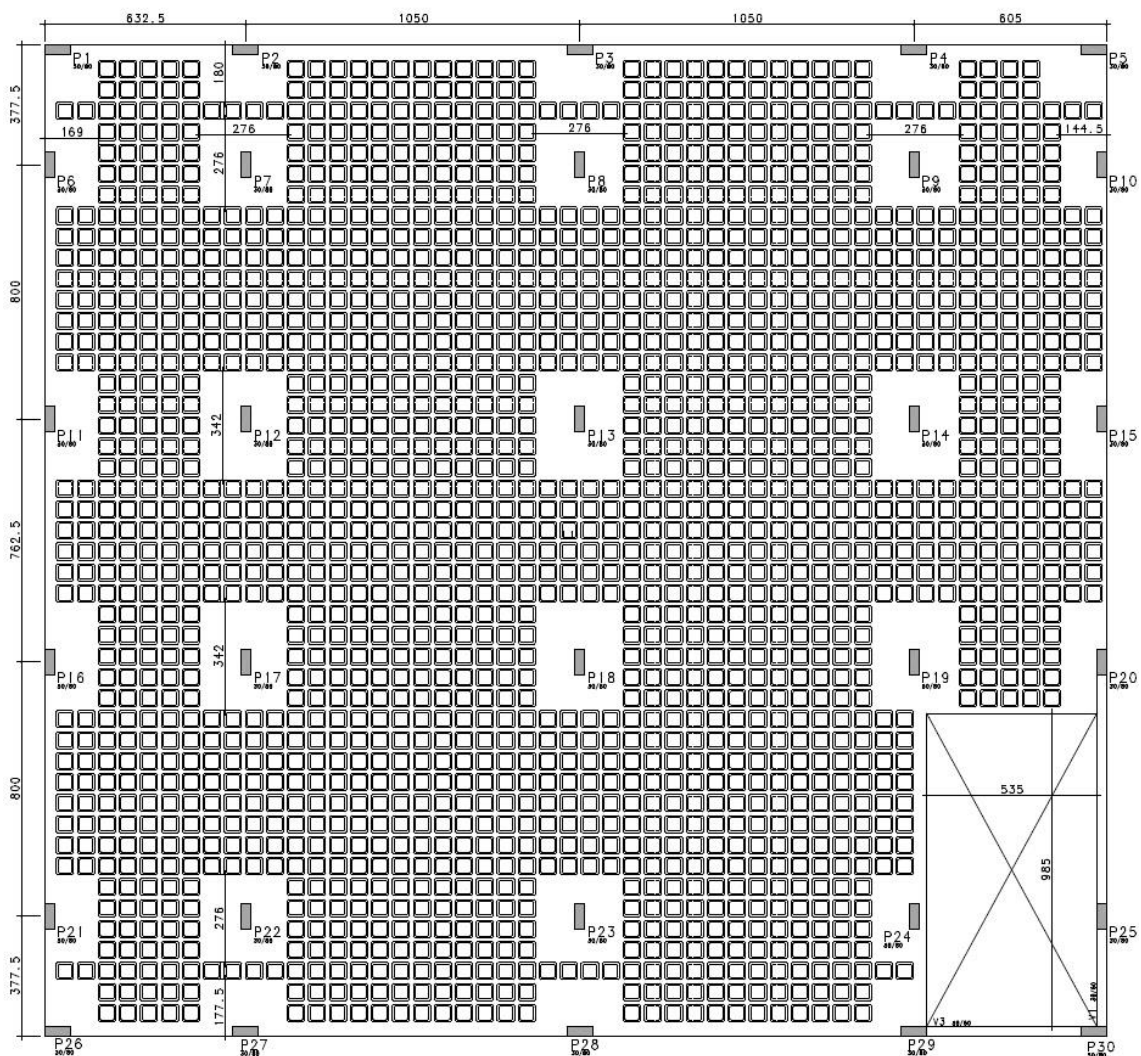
Projeto B1 - Planta de forma (dimensões em cm).
